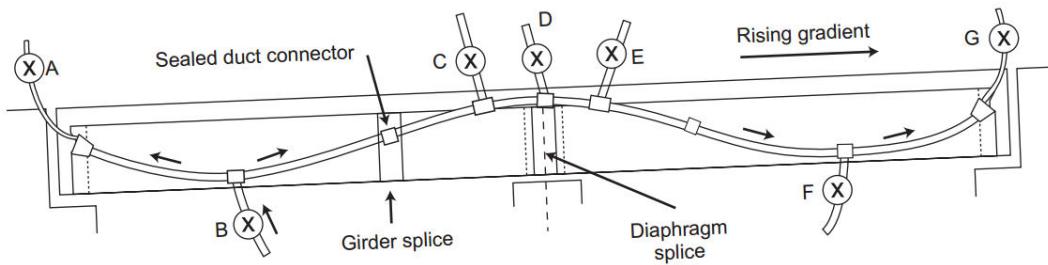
Detalles del grouting para un sistema de ducto de una viga principal empalmada de 2-tramos.
